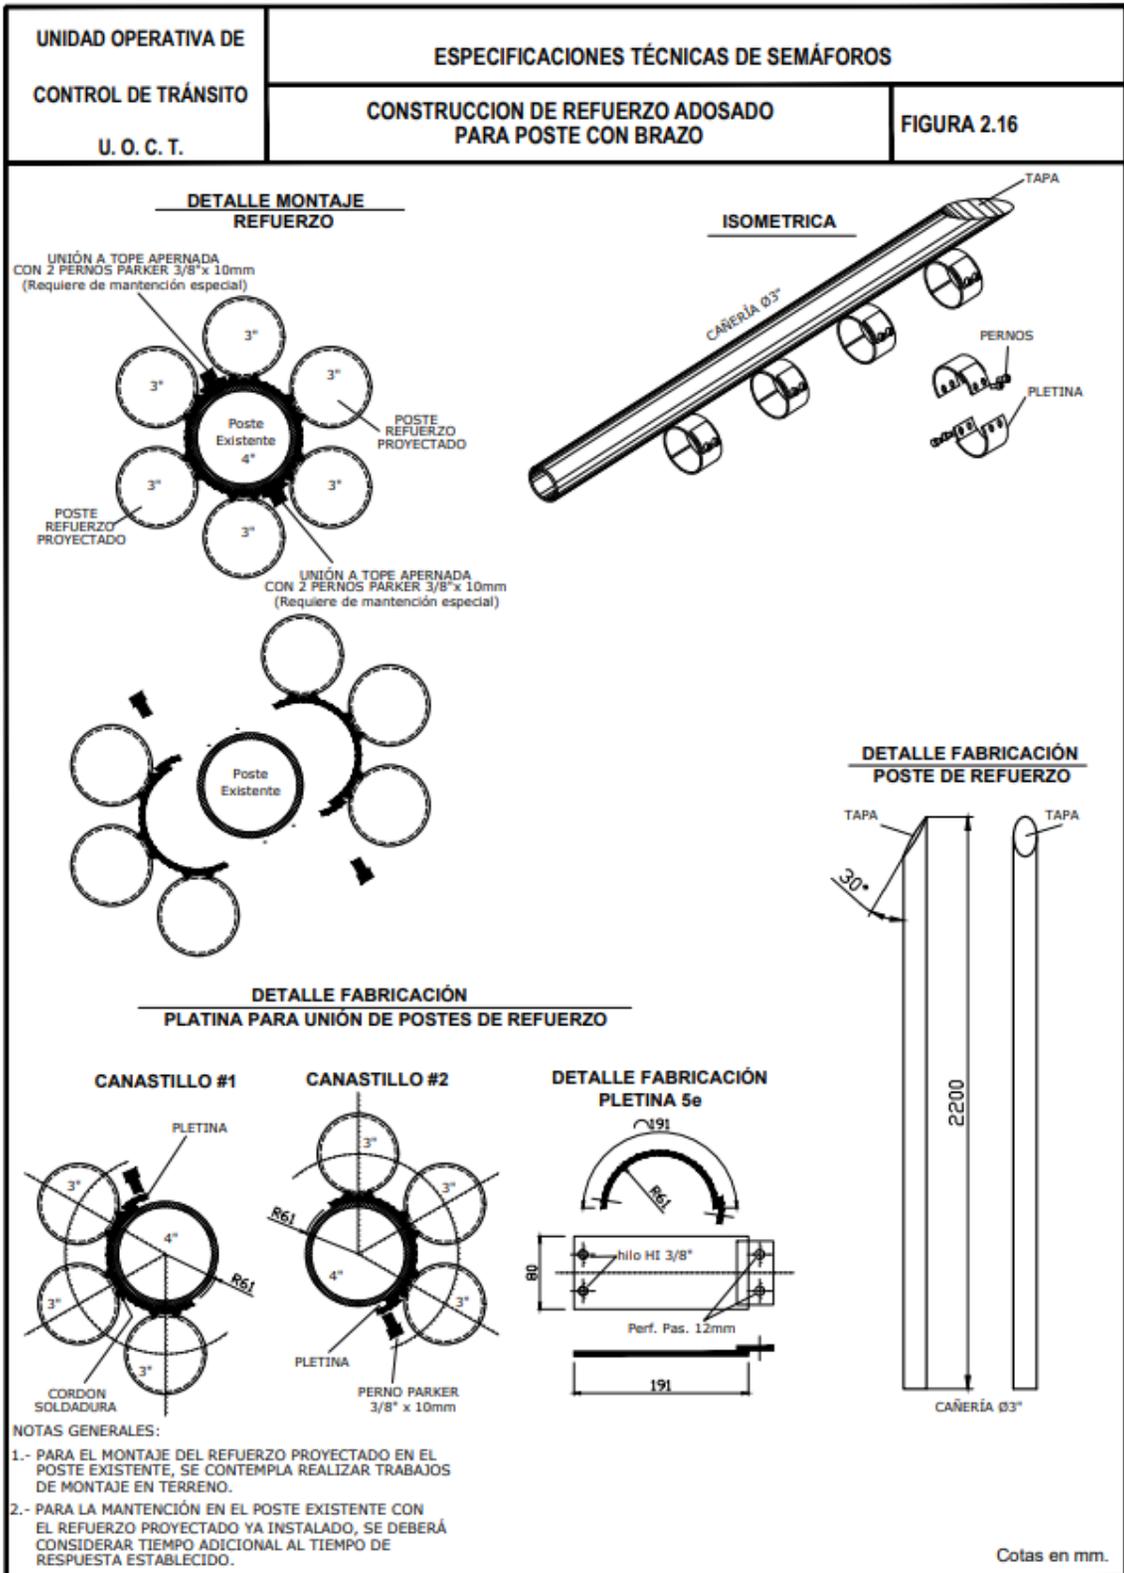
16 Construcción de refuerzo adosado para poste con brazo
